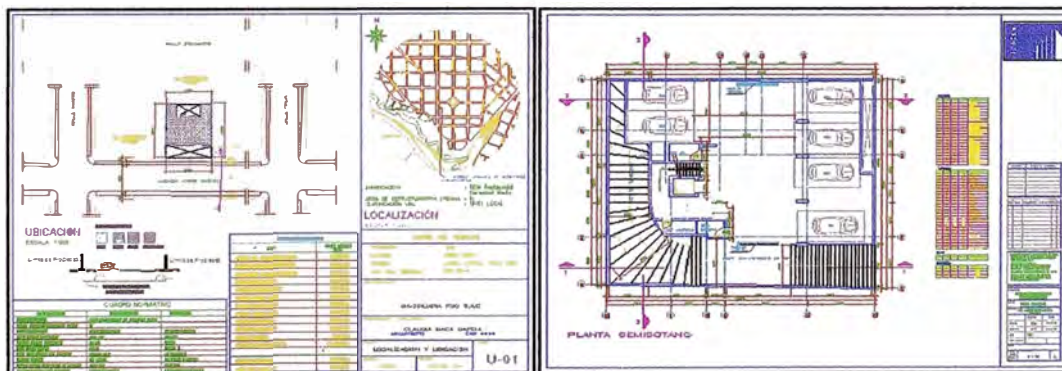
Planos de ubicación y planta de sótanos- Arquitectura
